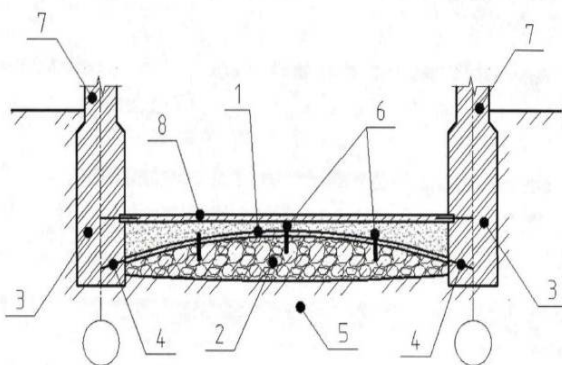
Схема перевлаштування стрічкових фундаментів в плиту перемінної жорсткості: 1 – армована оболонка підсилення; 2 – криволінійна штучна основа з нагнітанням розчину; 3 – існуючі фундаменти; 4 – глухий анкер; 5 – попередньо напружена природна основа; 6 – перфоровані ін'єктори; 7 – існуючі стіни; 8 – силова підлога
